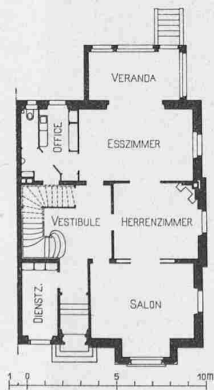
Erdgeschoss-Grundriss. — 1 : 400.
